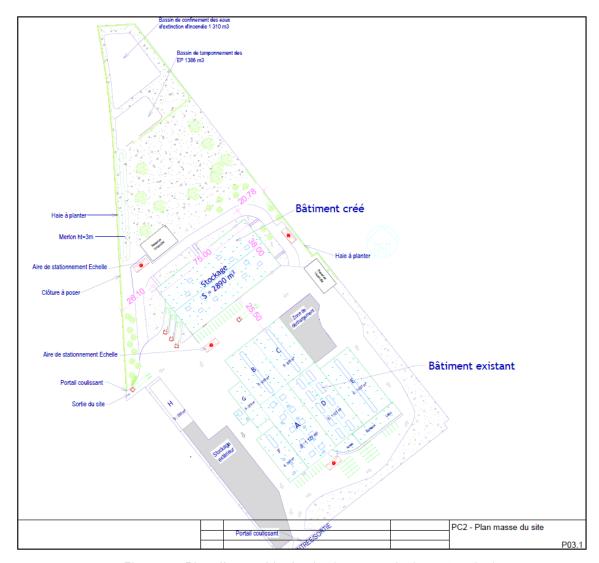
Plan d'ensemble du site (source : sicabconstruction)
